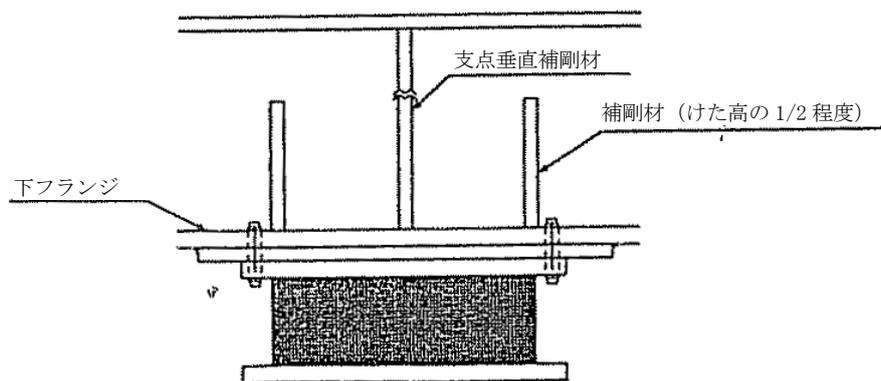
垂直補剛材による支承上の鋼橋腹板の補強例
